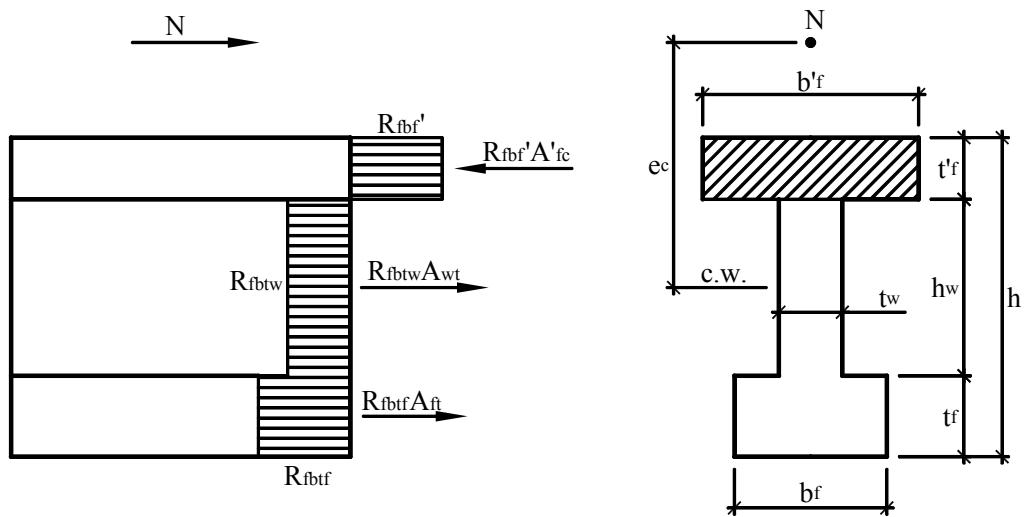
Схема усилий и эпюра напряжений во внерадиально сжатых элементах двутаврового сечения при фиброном армировании, $x \leq t'_f$
